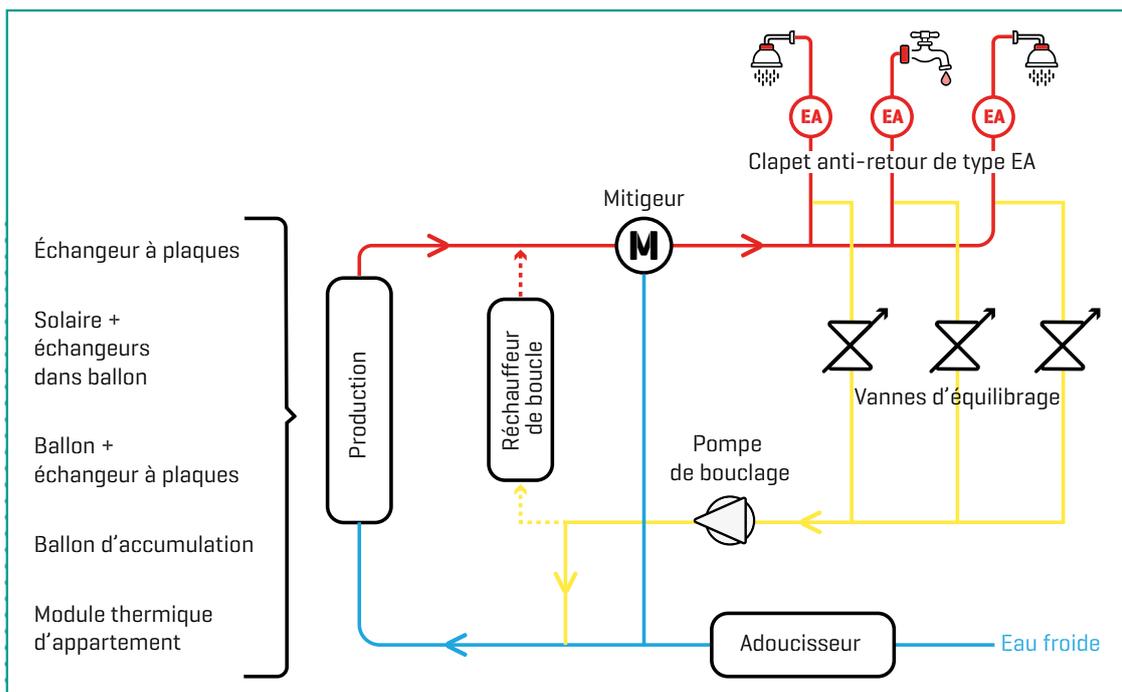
schéma de principe d'une installation d'eau chaude sanitaire
